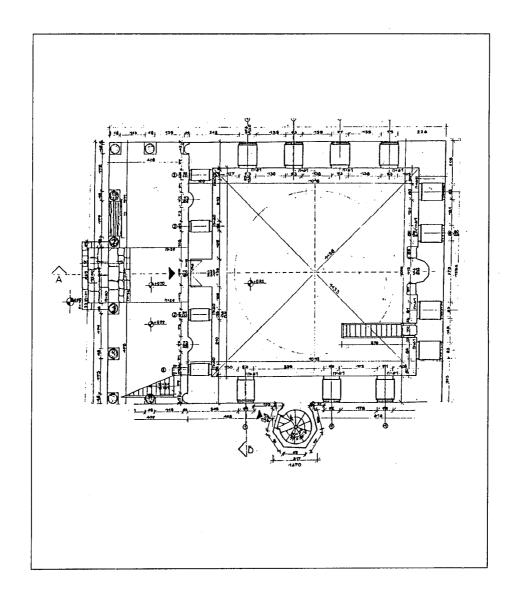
مسقط أفقي للمسجد الجديد (يني جامع) في كوموتيني (عن : كيل) .
